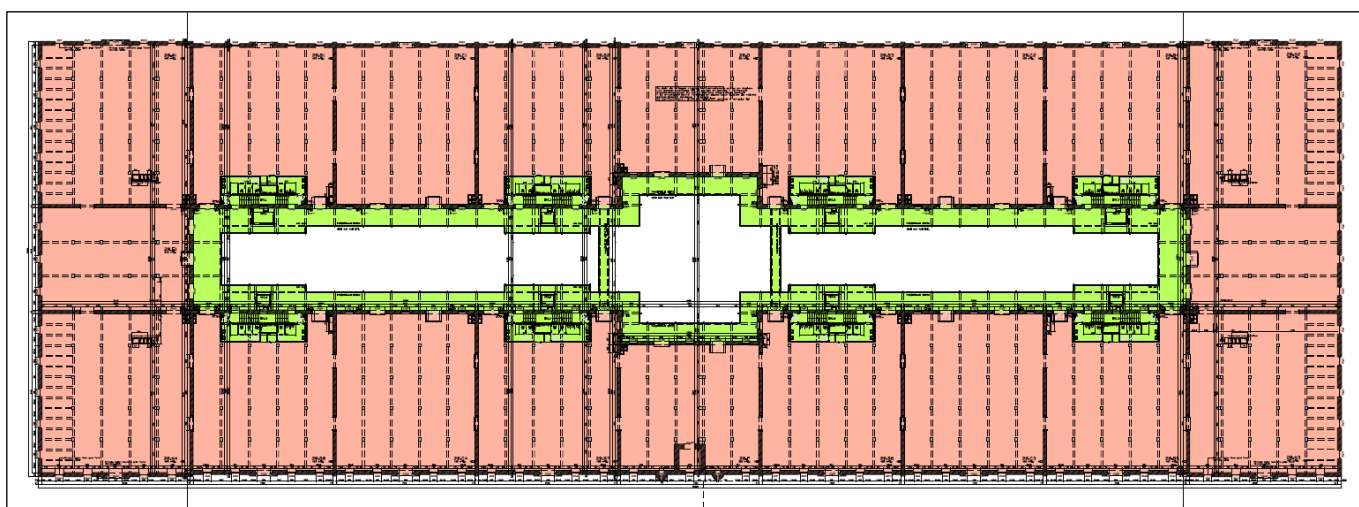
, Bâtiment B, situation existante de droit – 2<sup>ème</sup> étage
